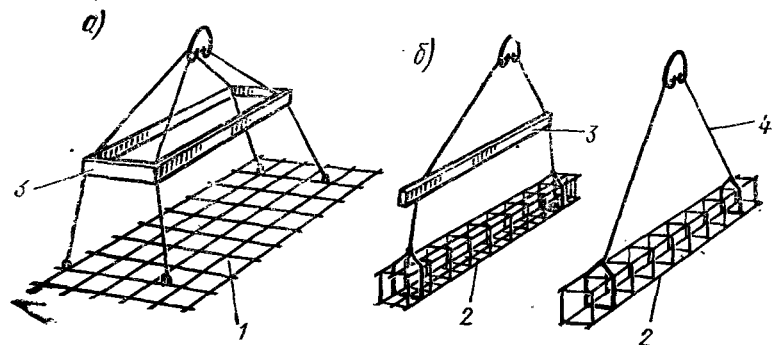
Строповка арматурных заготовок при монтаже:
